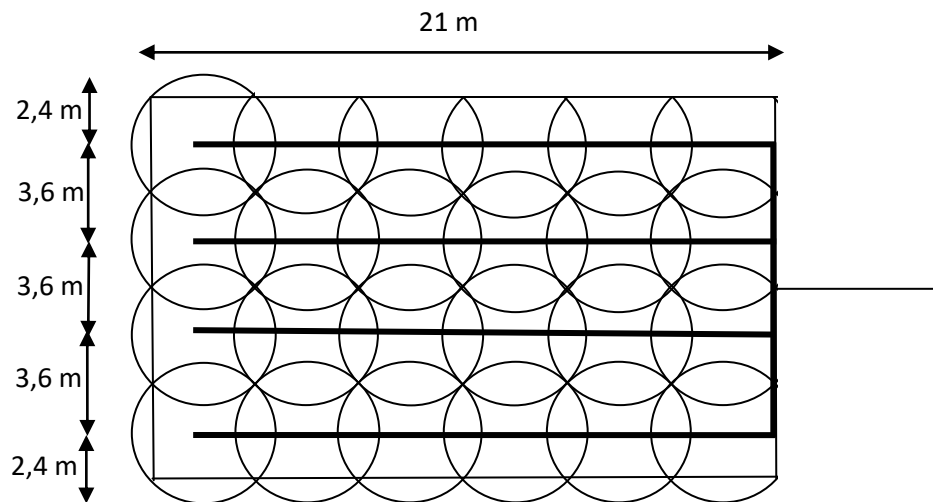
Vista en planta del sistema de rociado del biofiltro.
